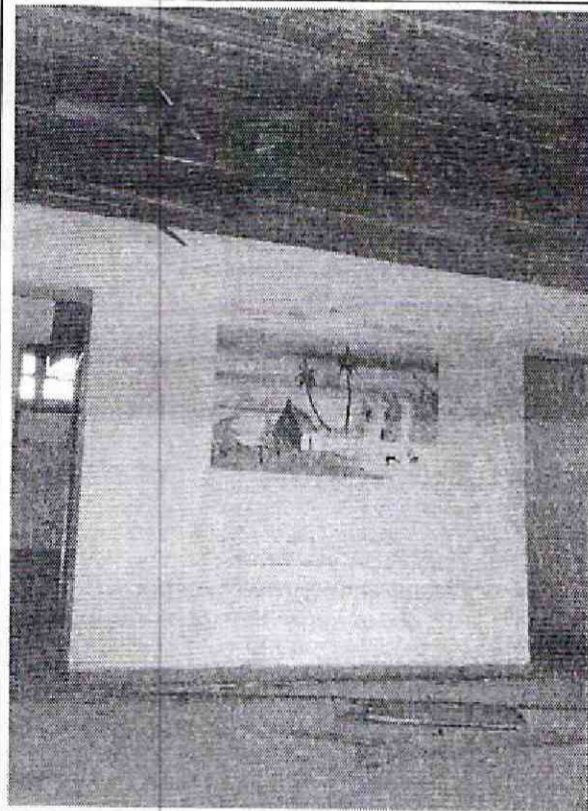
Vista interior muro segundo piso. Agrietamiento perceptible a simple vista
